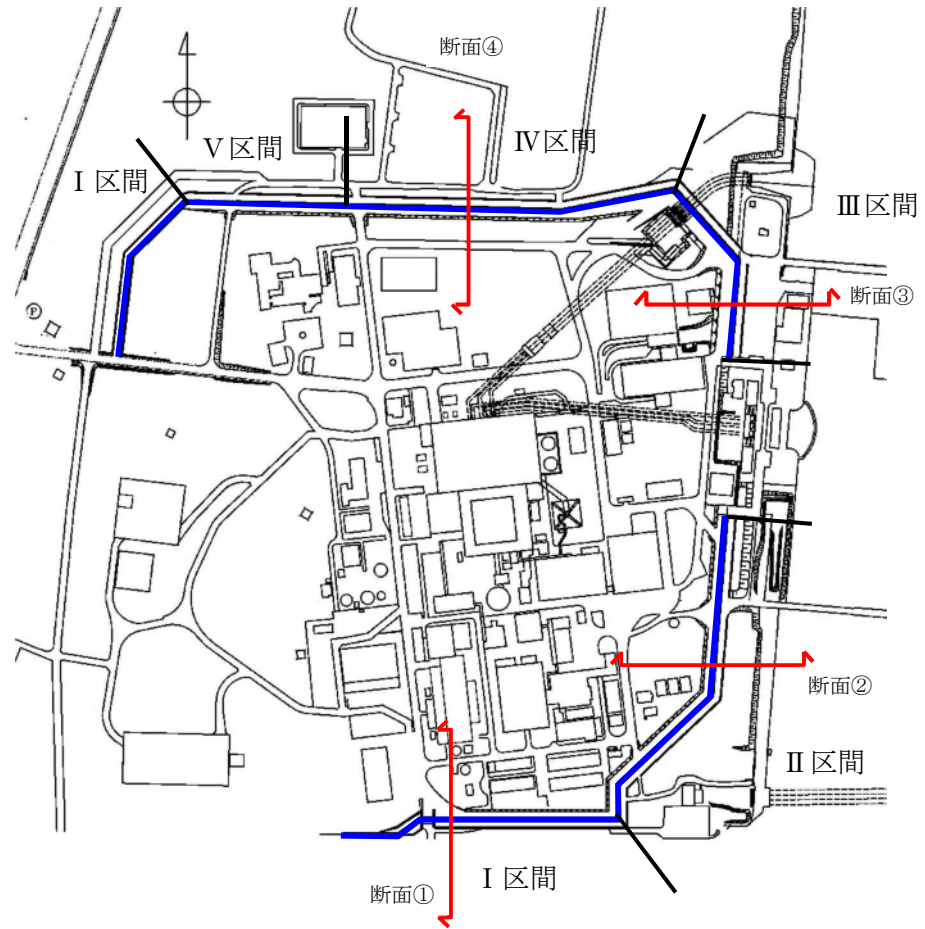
鋼管杭鉄筋コンクリート防潮壁の評価対象断面位置図
